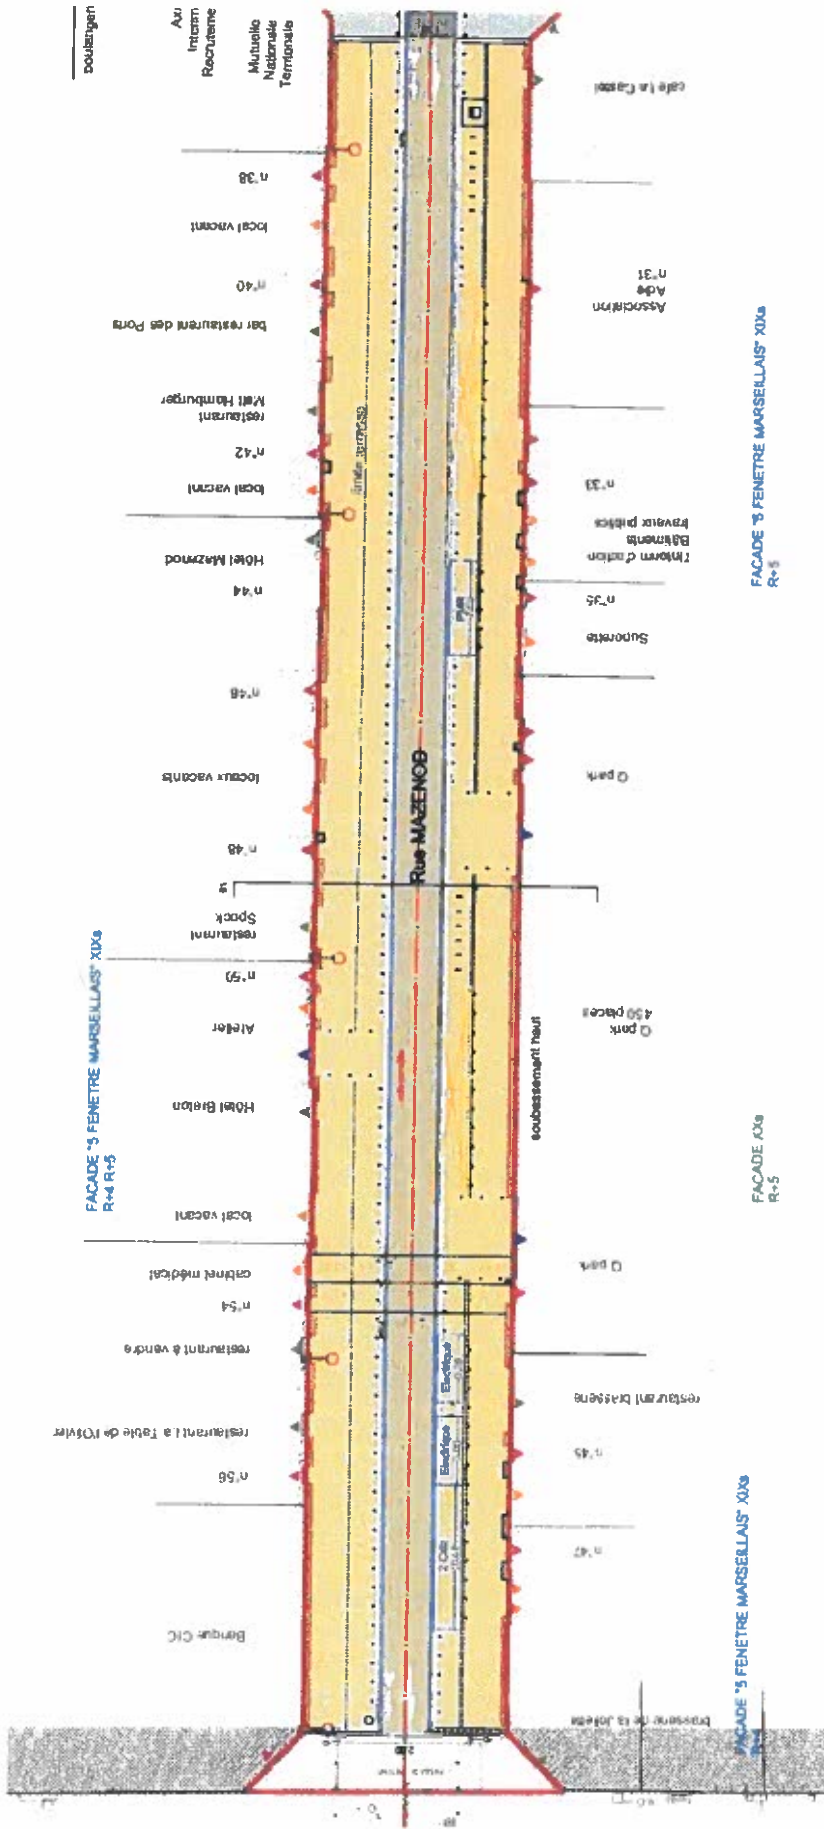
Plan Général des Travaux (1/5) – Section rue Mazenod entre la place de la Joliette et le boulevard des Dames
